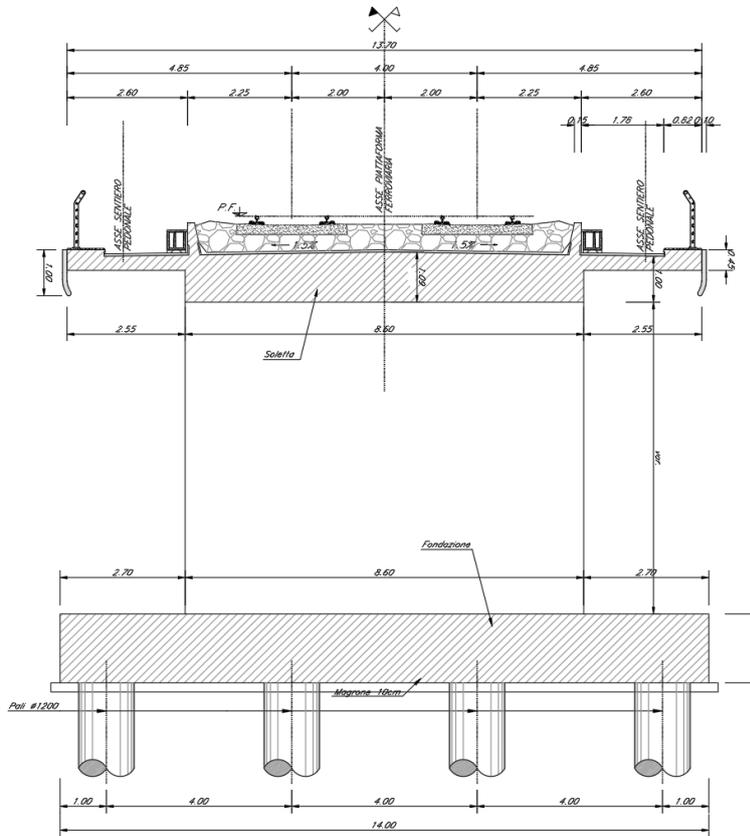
Sezione tipo del manufatto con setto trasversale
